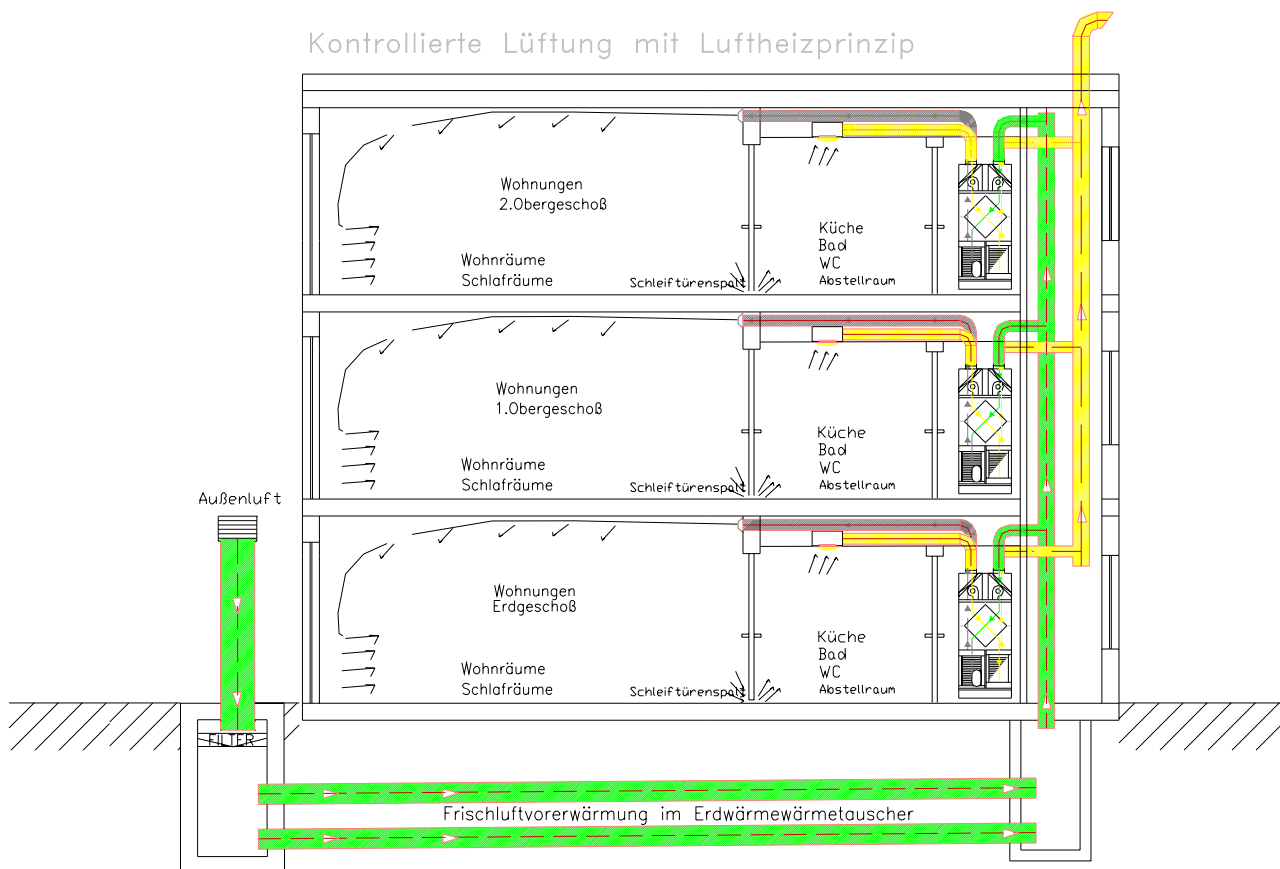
Haustechnik Schnitt, Projekt "Ölzbündt"
